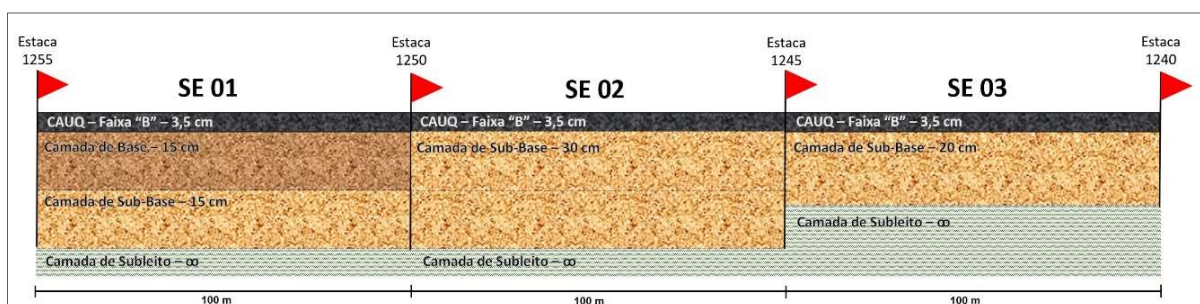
Ilustração das seções transversais da estrutura do pavimento dos segmentos experimentais na BR-432/RR.
